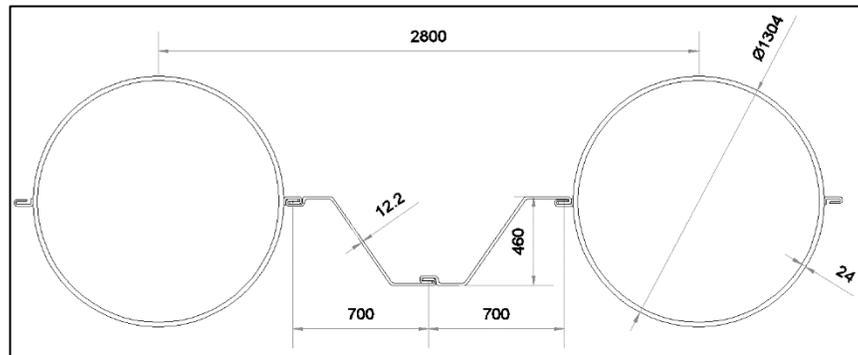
Sección tipo de la tablaestaca a utilizar en la pared exterior, del sistema combinado de doble muro.
